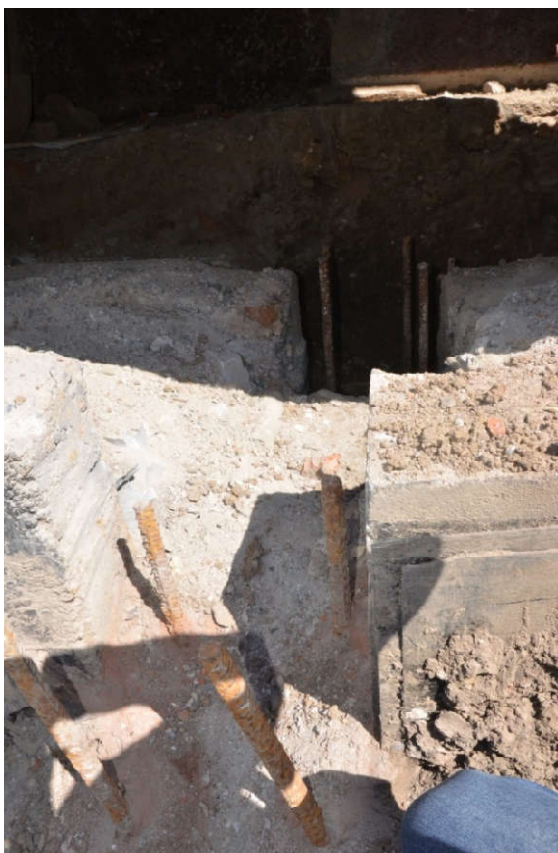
Фундамент Ф8 в осях Э-И/14-16
